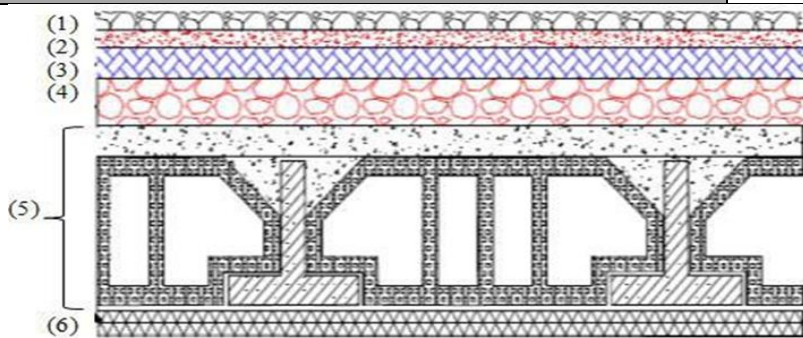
Coupe verticale du plancher terrasse à corps creux.
